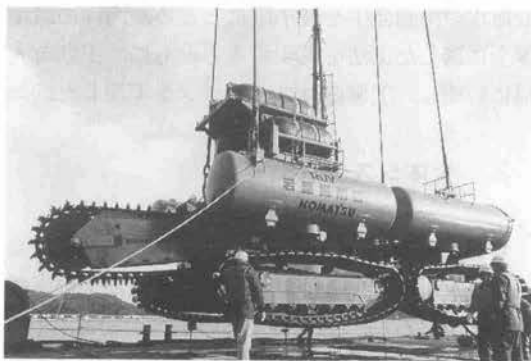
海底岩盤掘削機本体（溝掘削仕様）
